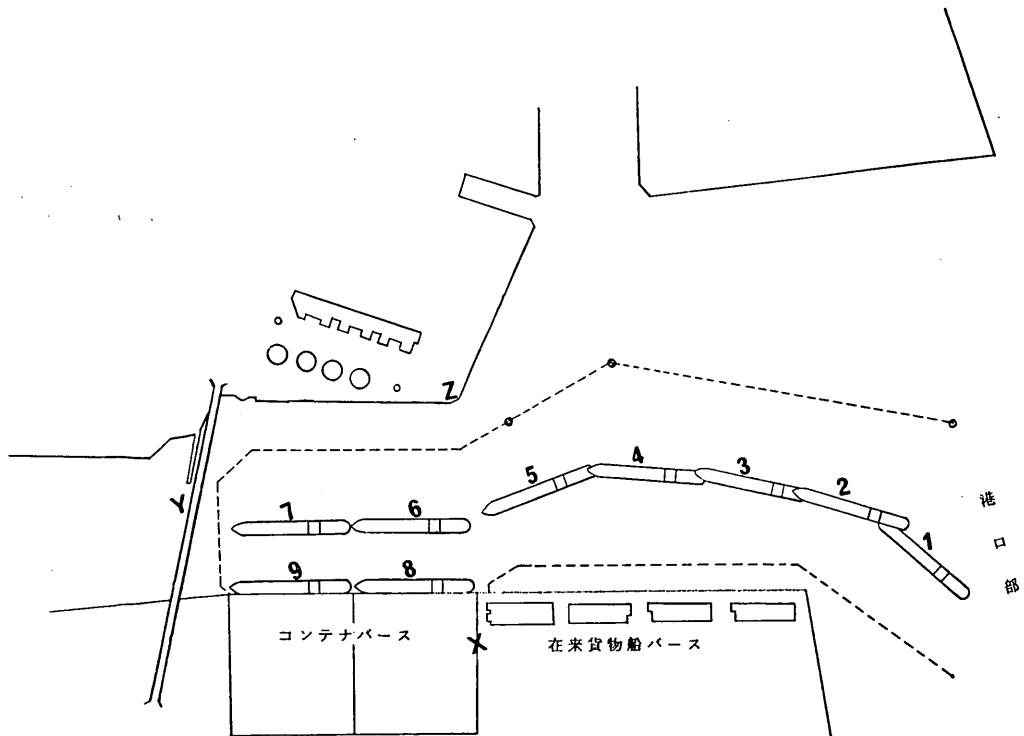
大黒埠頭コンテナバース周辺の景観原型平面図
